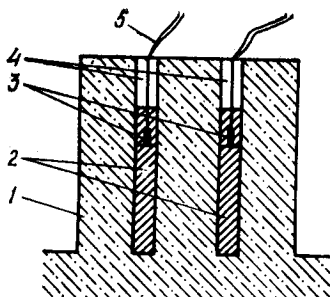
Схема размещения шпуровых зарядов при разрушении фундамента:
